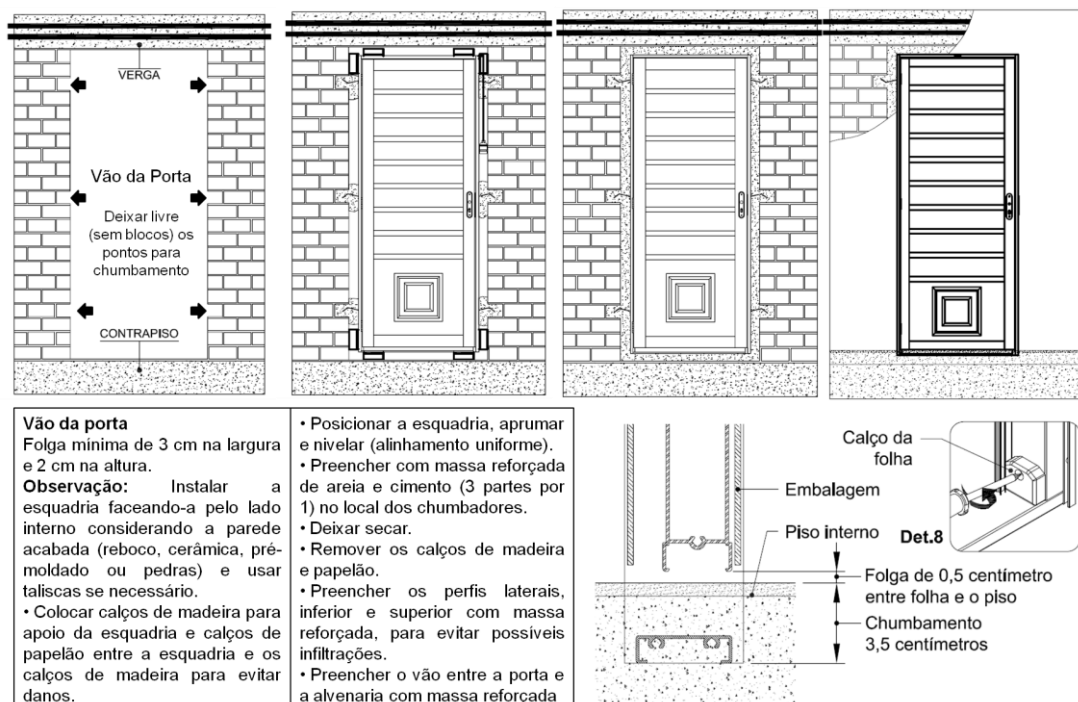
Processo de instalação de portas de aço e de alumínio segundo fabricante
